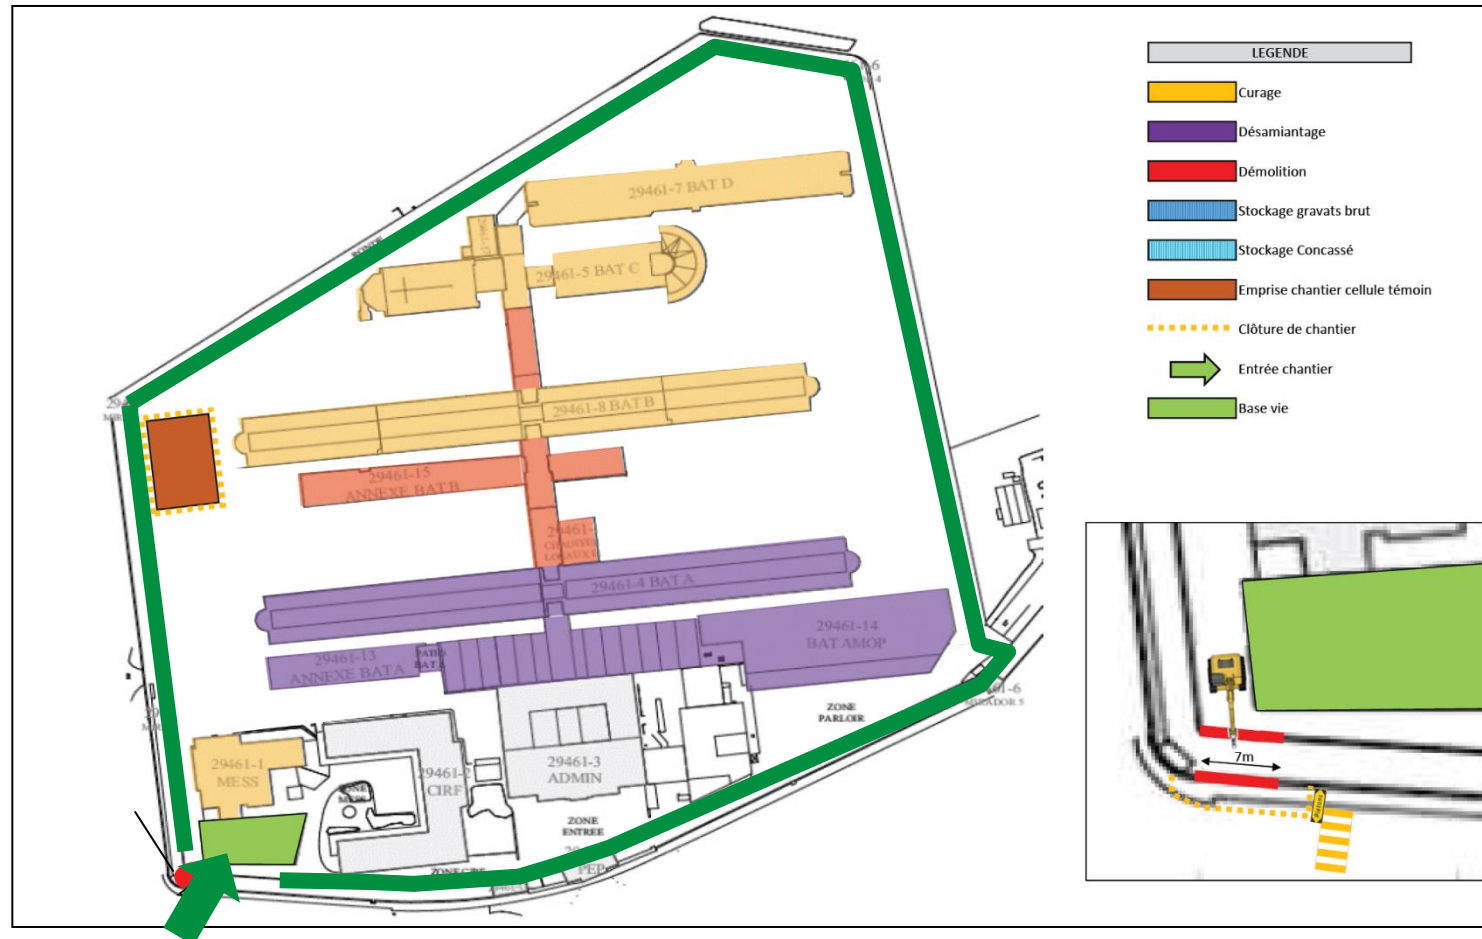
travaux de démolitions, planche 2 (source : dossier de demande d'autorisation de travaux)
